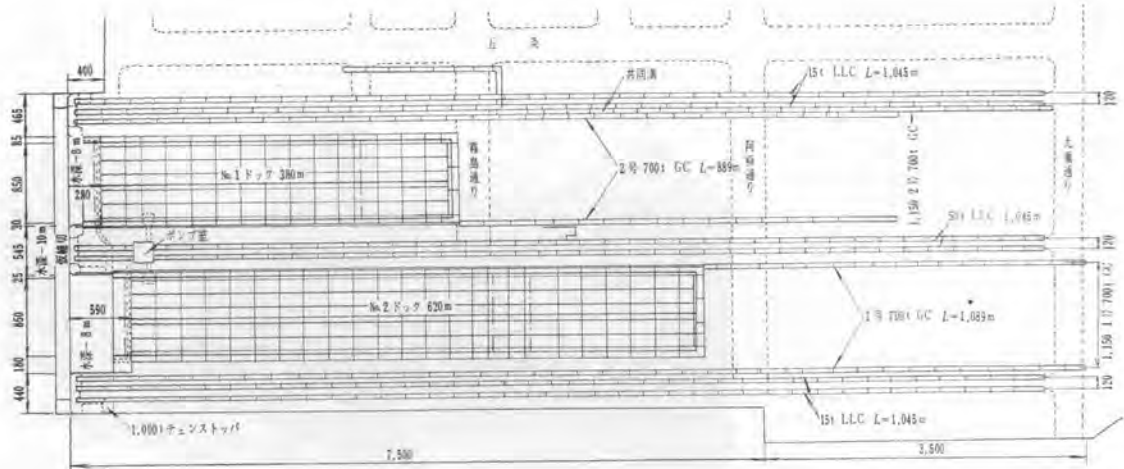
ドック一般平面図 (No. 1, No. 2 ドック)
